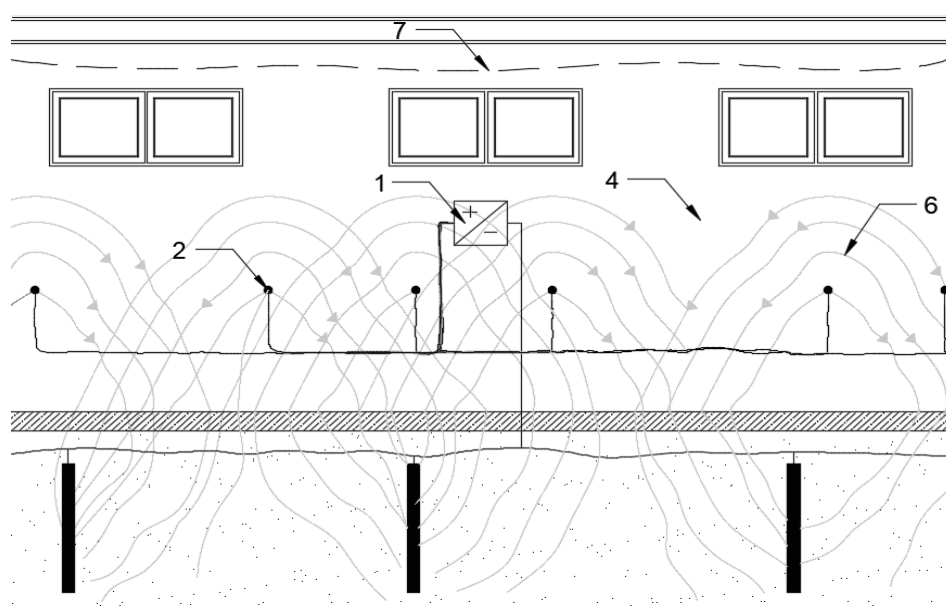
Вариант схемы установки, расположенной на цокольном этаже здания
